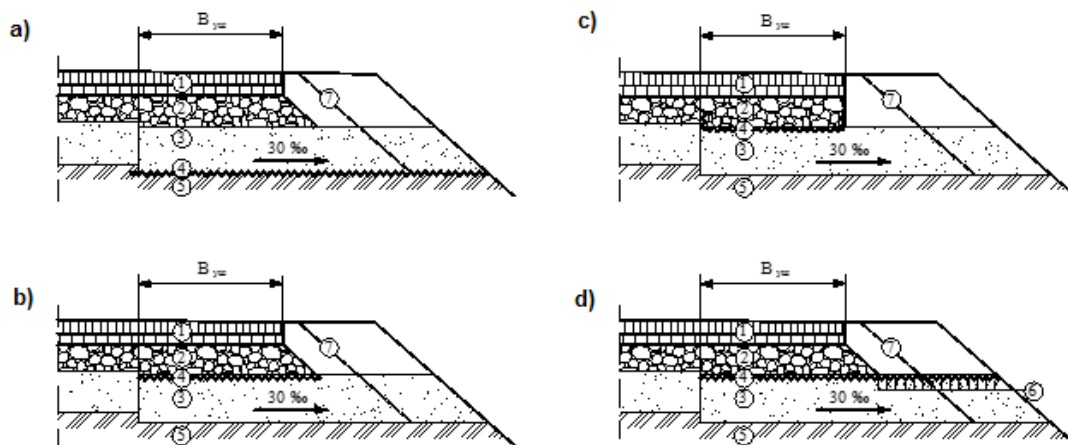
Soluții constructive de bază pentru cazul supralărgirii structurilor rutiere prin executarea substraturilor cu rol de protecție și drenare (a), cu rol protecție și armare sau cu rol de protecție b, c, d)
